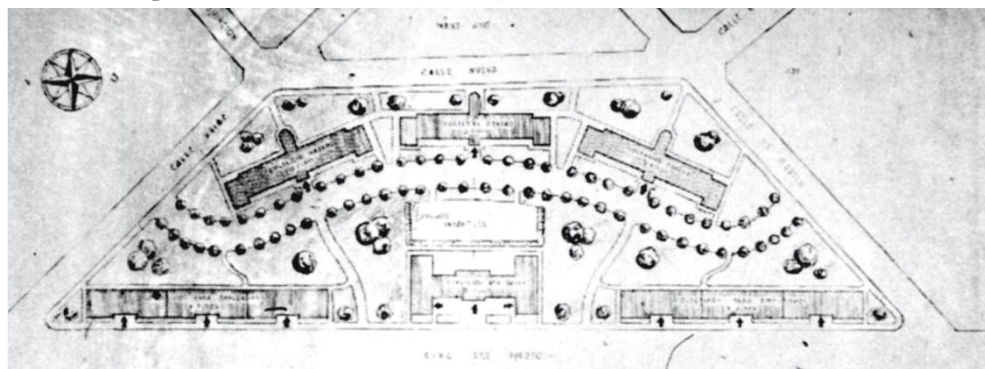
Planta de conjunto, Plan Original (solo se construyen 3 pabellones). Archivo C. Galeno.
